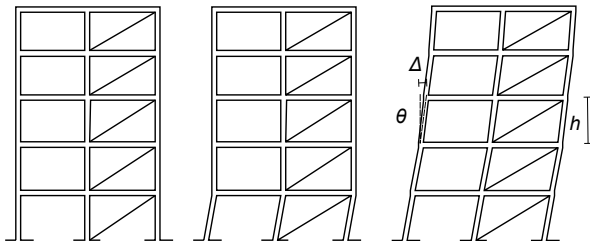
Desplome de pórtico articulado arriostrado. El alargamiento de las diagonales es la variable fundamental en tanto el pórtico no alcance alturas importantes.
